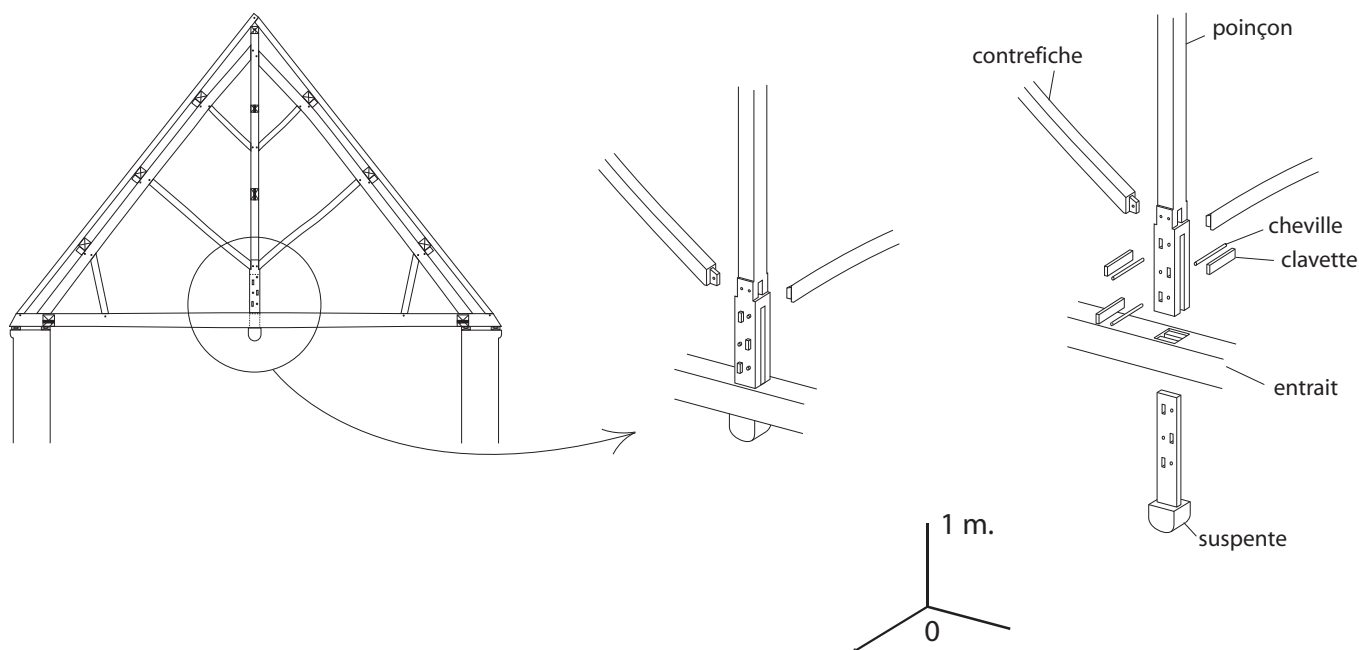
Suspensoir du pied de poinçon d'une ferme (1241d).
